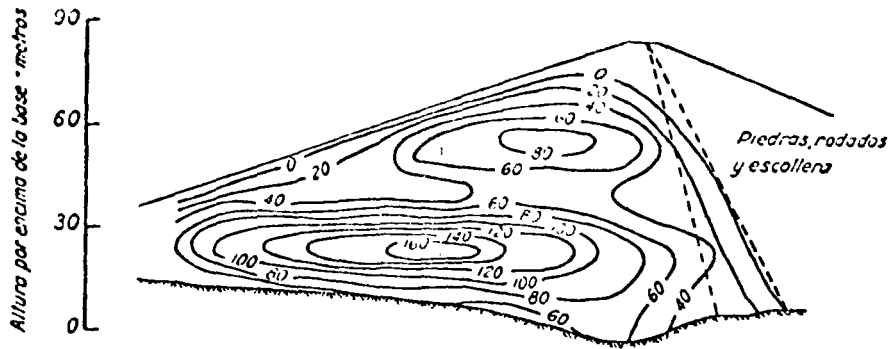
Presiones de poros en metros medidas en la zona impermeable de la presa Great Mountain al término de la construcción (según Walker y Dahn, 1948).
